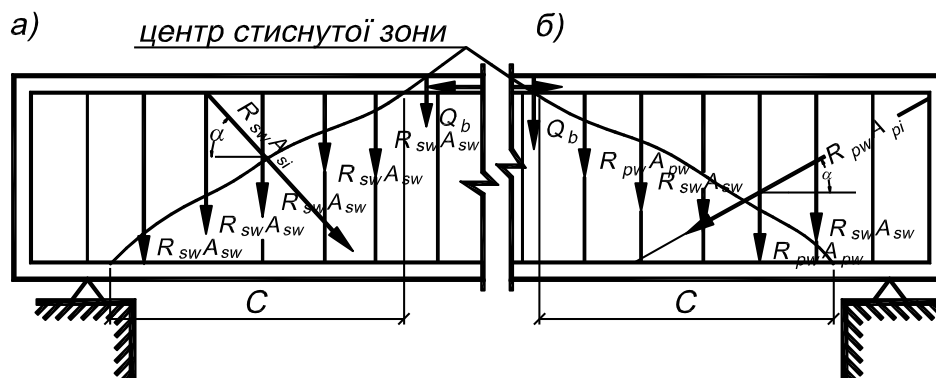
Схема зусиль у перерізі, нахиленому до поздовжньої осі залізобетонного елемента, при розрахунку його міцності на дію поперечної сили
